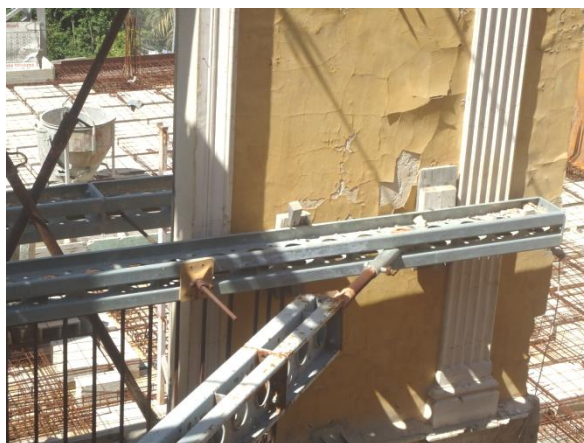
Fisuras y desprendimiento del revestimiento alrededor de la zona de apoyo de las cuñas de madera y las correas horizontales de un estabilizador, situado en la c/Mayor de Ontinyet (Valencia).
